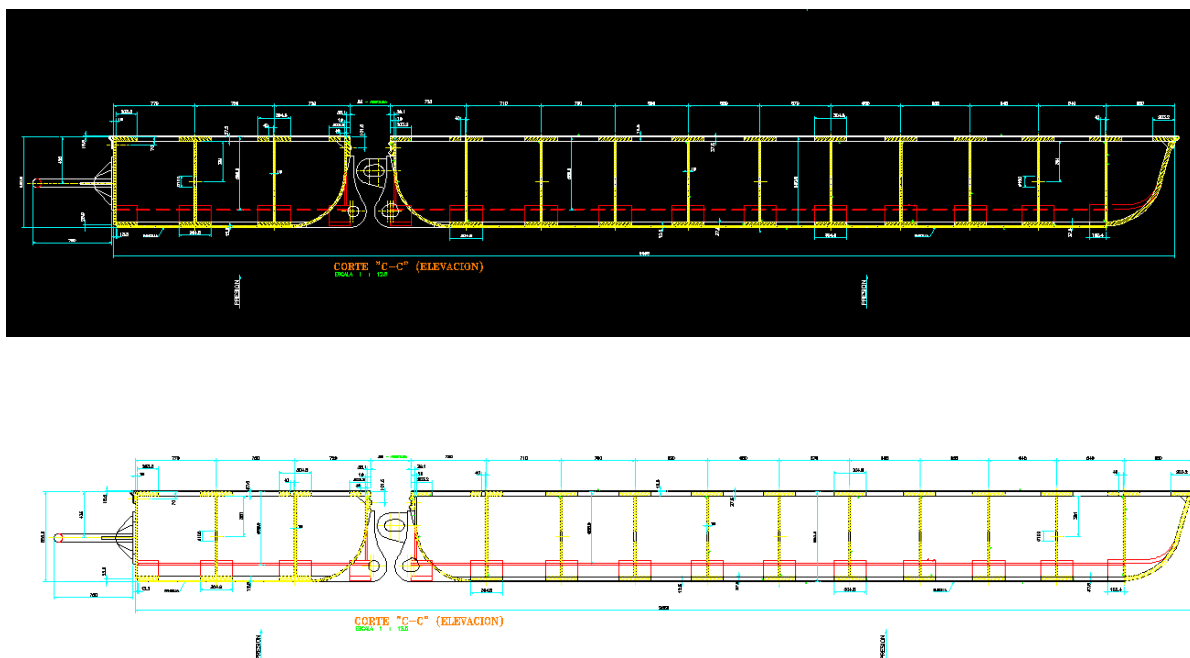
Vista de la sección transversal de la compuerta deslizante
